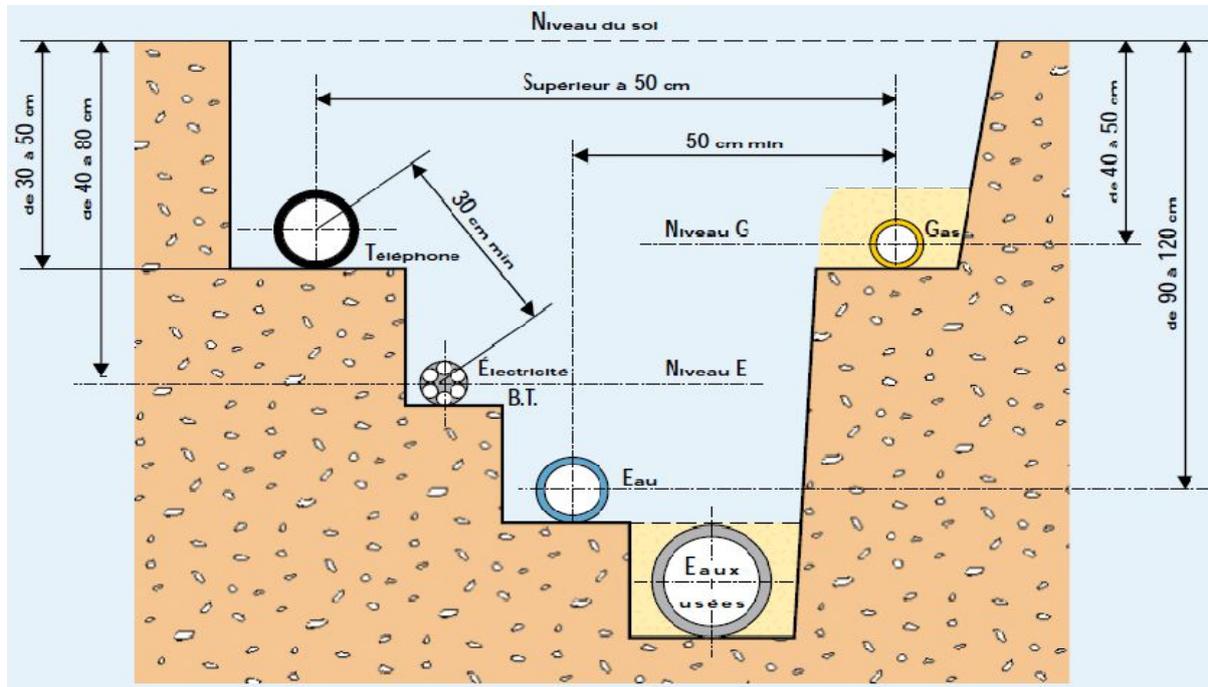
Croisement des réseaux (Hamdane, 2014)
